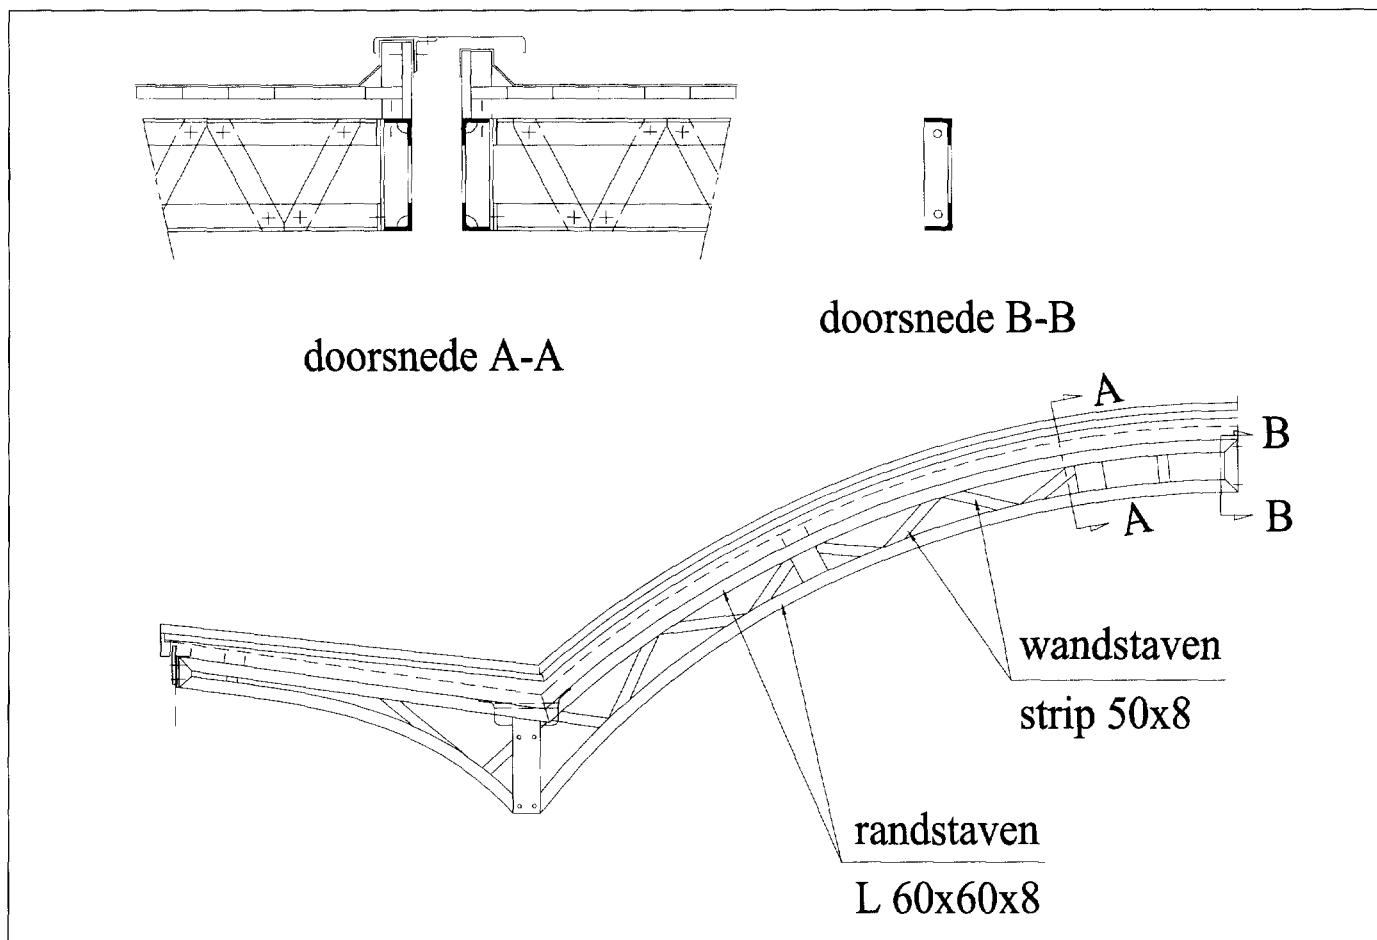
De constructie in de nok van de spanten wordt lokaal versterkt door strippen in te lassen. (Tekening Holland Railconsult, Utrecht)
